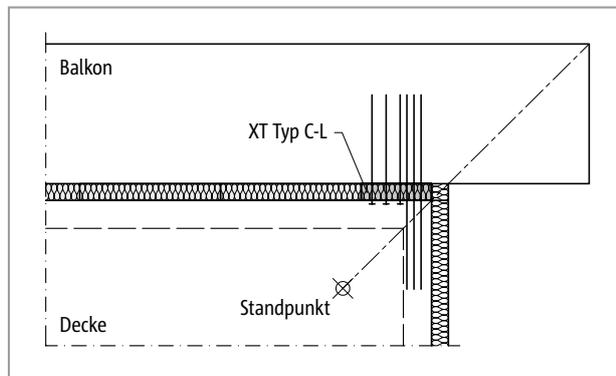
Schöck Isokorb® XT Typ C: Balkon über Gebäudeecke auskragend (Einsatz XT Typ C-L)
